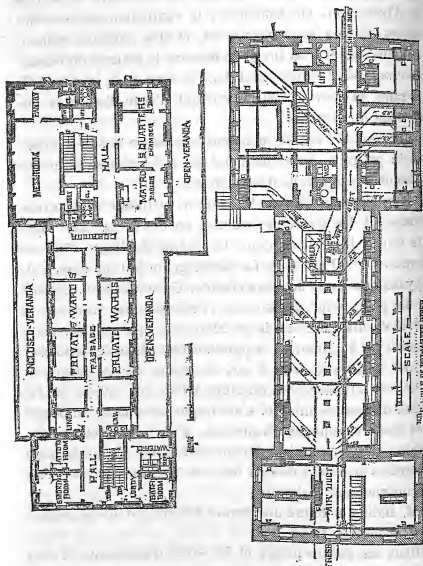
et 15. — Barnes Hospital; plan du rez-de-chaussée et du premier étage.
